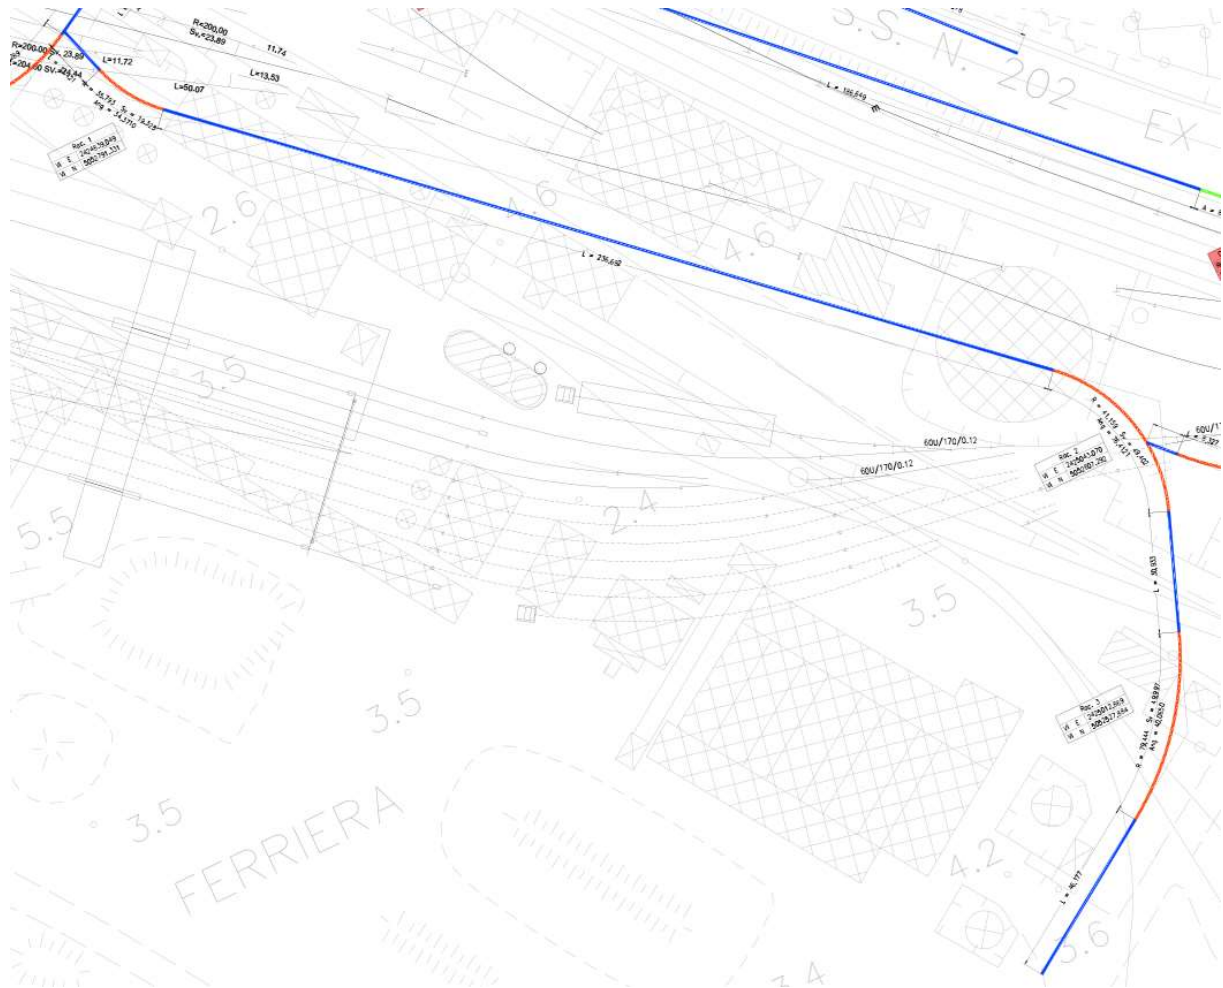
Andamento dell'asse stradale - Ingresso all'area ARVEDI.
